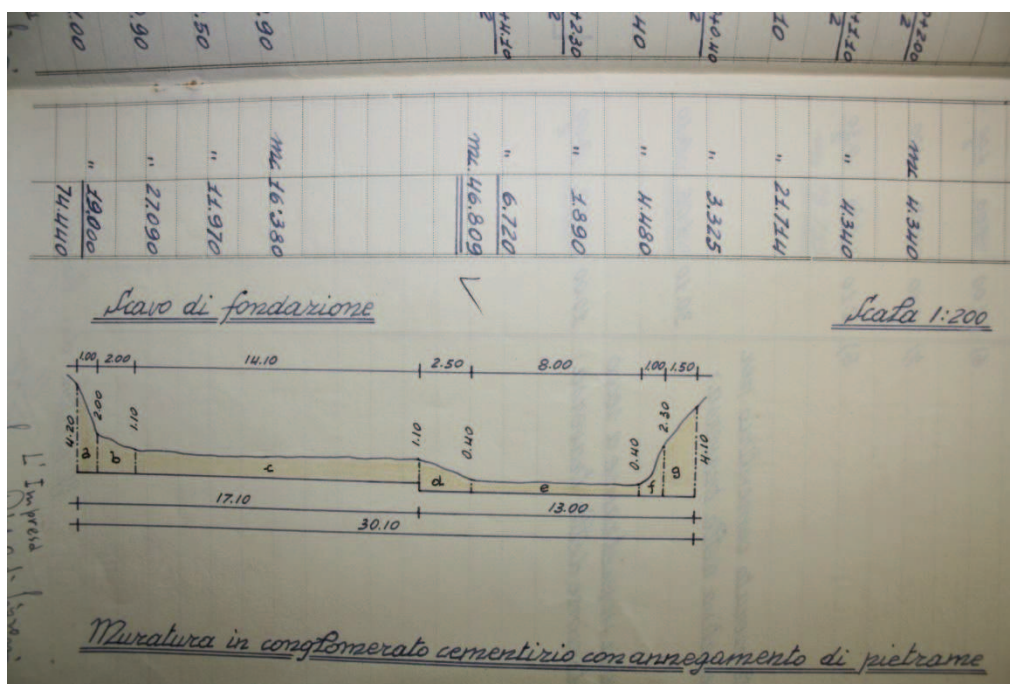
Dettaglio dello scavo di fondazione. Archivio CFS Brescia, 2011.
